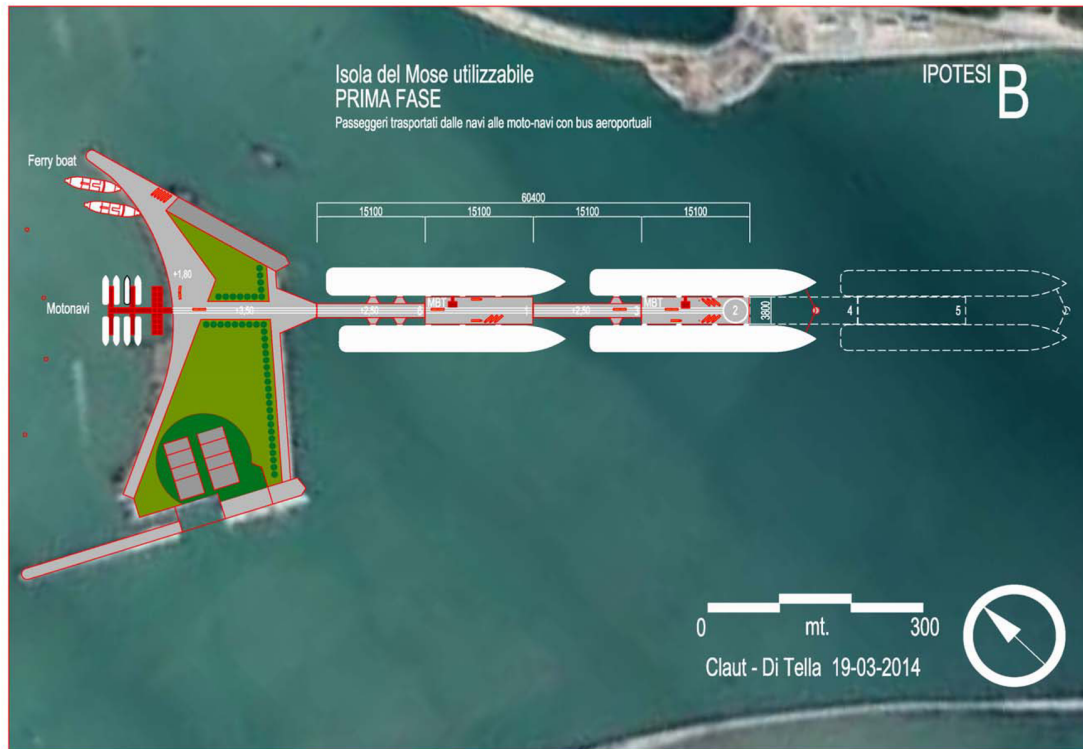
Planimetria d'insieme con l'inserimento dell'avanporto (soluzione B).
